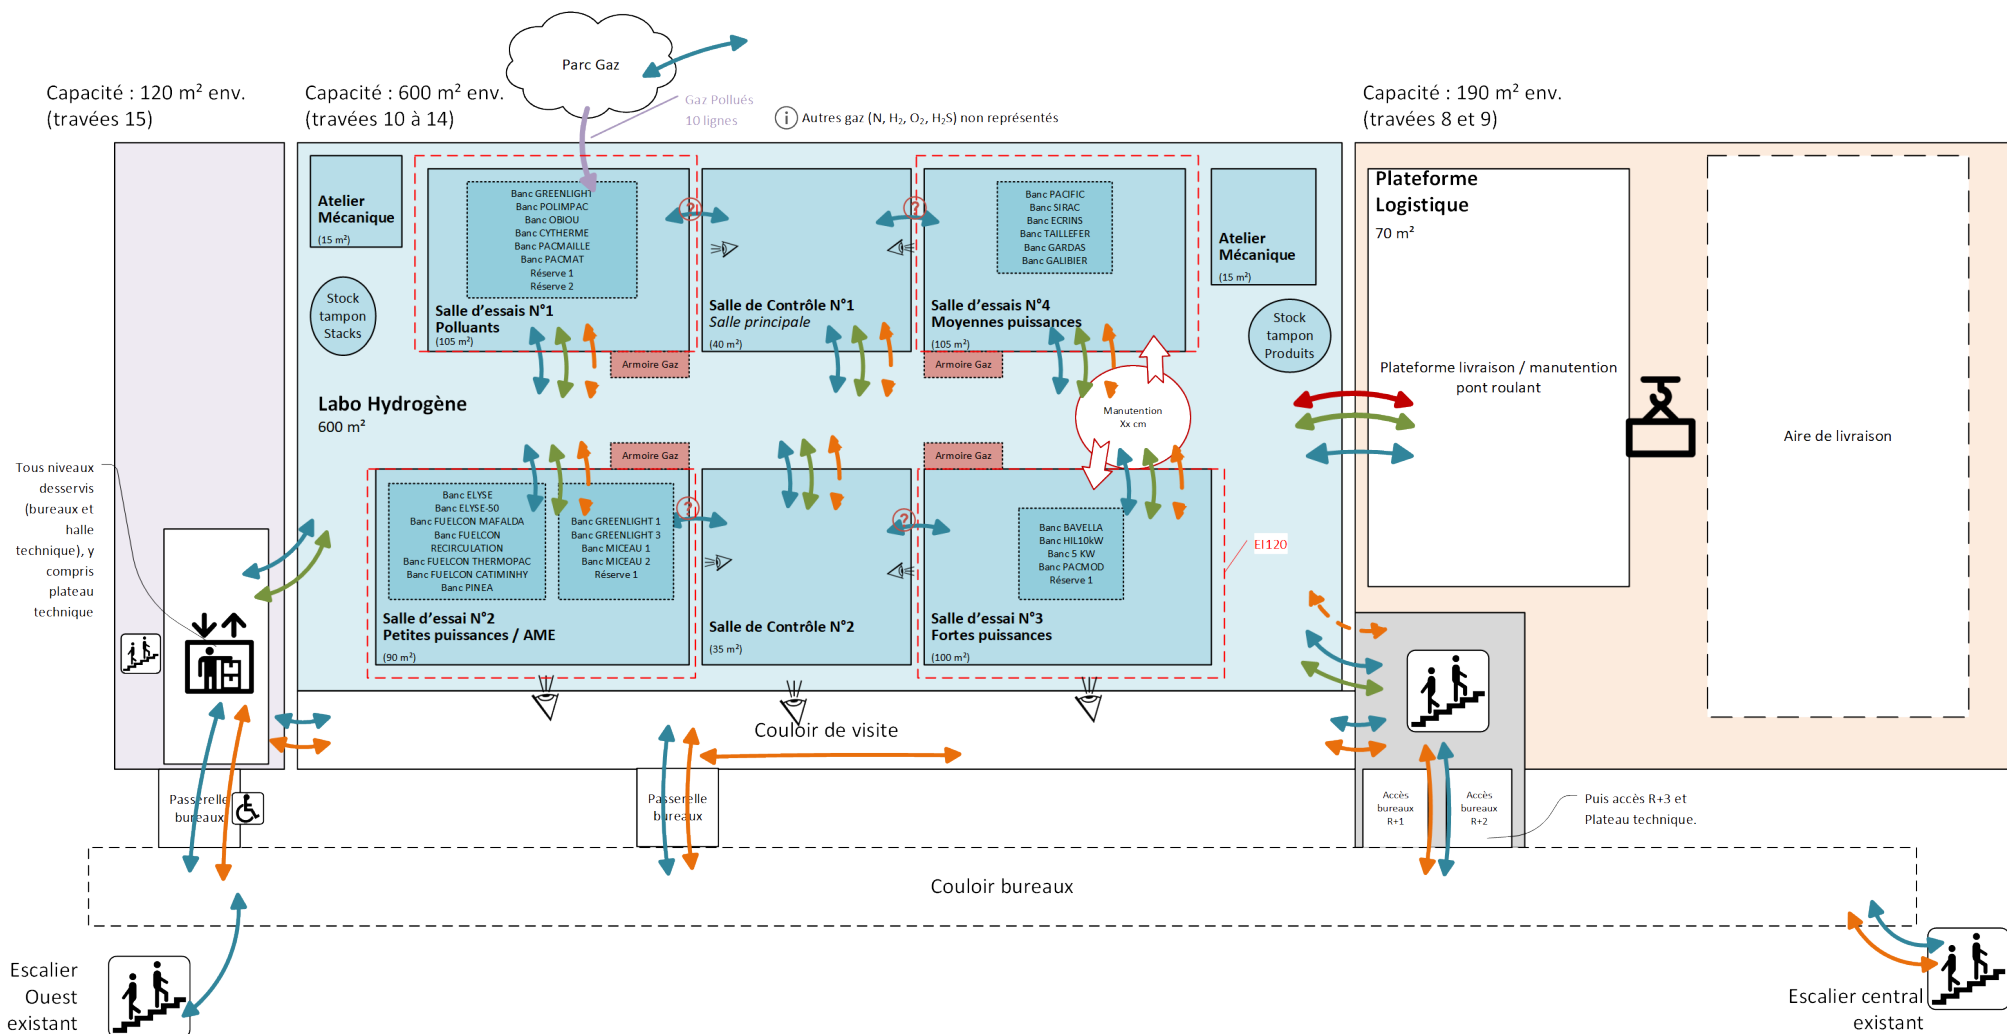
Plan Fonctionnel - Niveau R+1 (Nord en haut)
